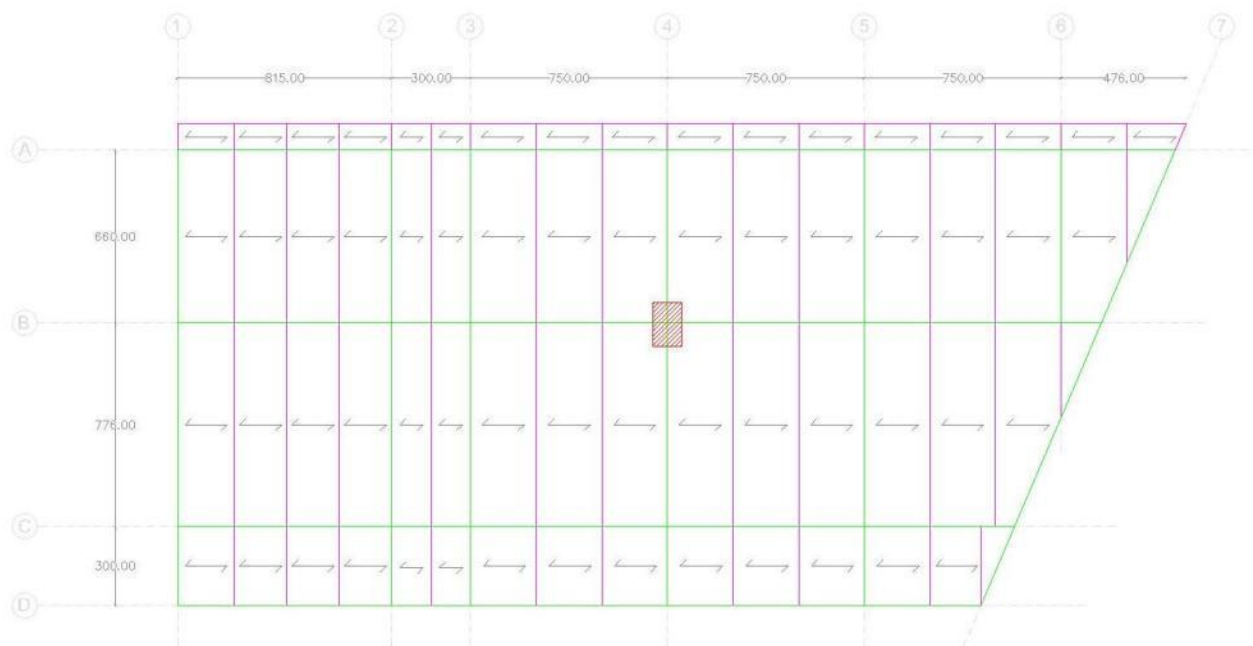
Individuazione del pilastro nello schema del solaio di copertura
